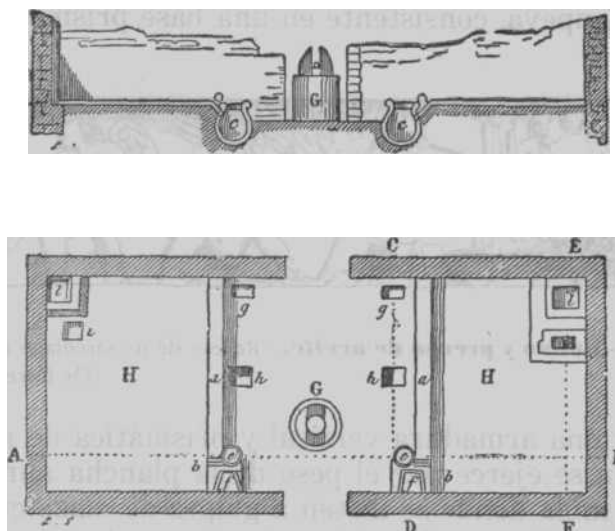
Sección y planta del torcularium de Stabia.
